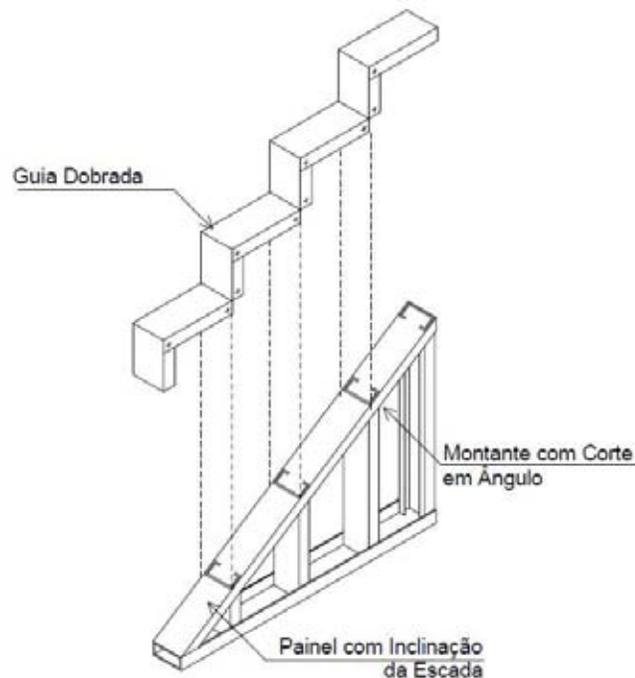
Escada do tipo viga caixa inclinada (Adaptado de FREITAS; CRASTO, 2006)
